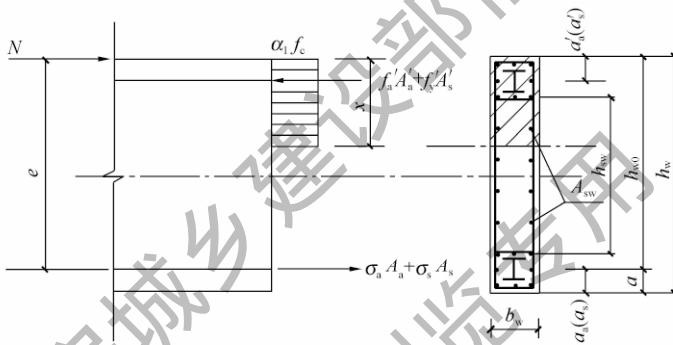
型钢混凝土偏心受压剪力墙正截面受压承载力计算参数示意
